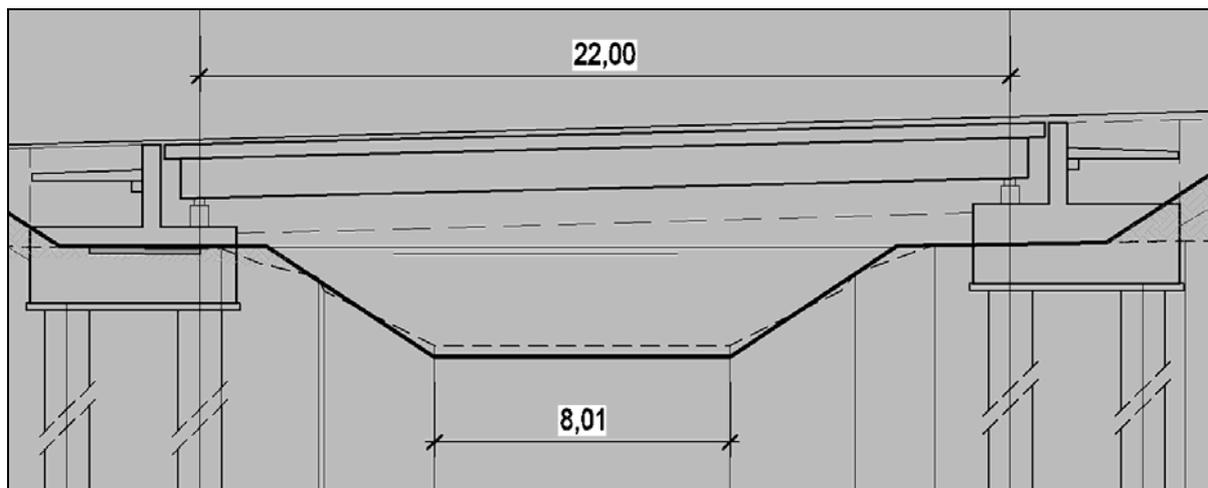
PONTE SUL CANALE DIVERSIVO DI CAVEZZO
